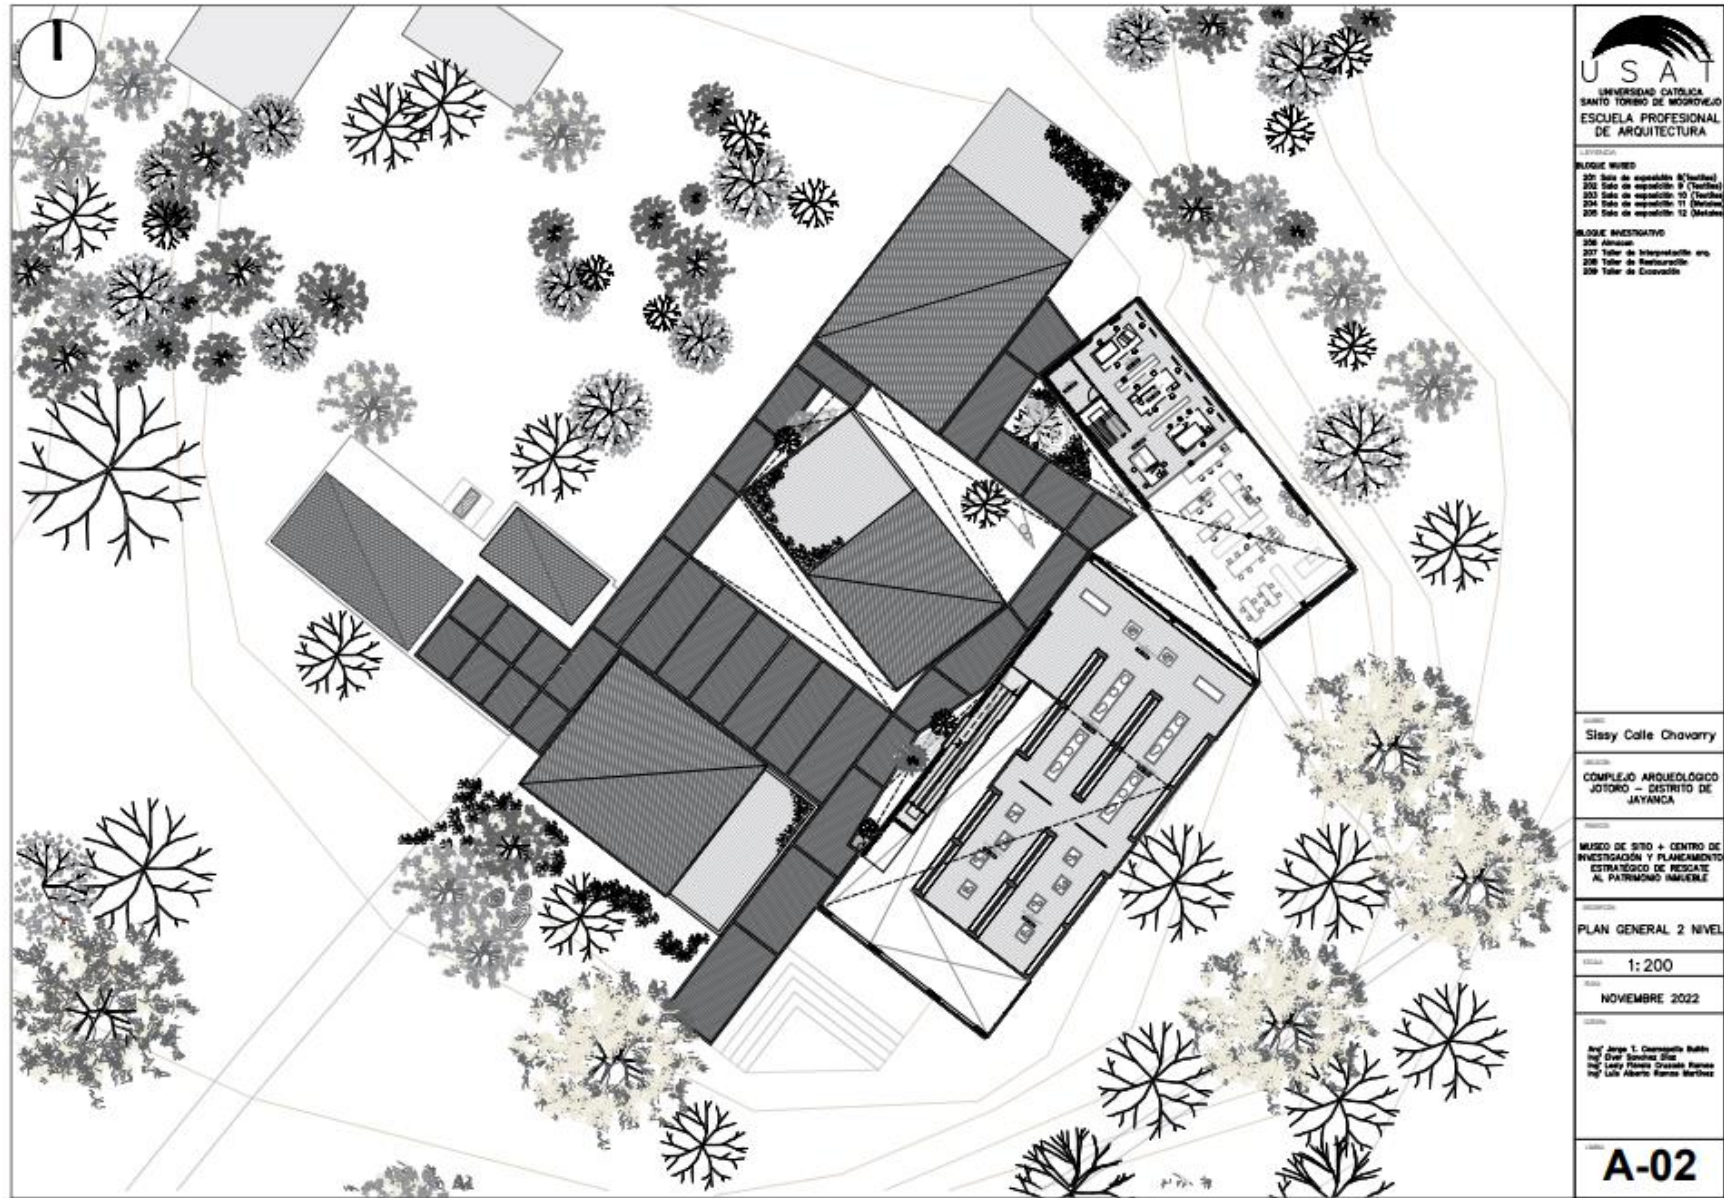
Planta arquitectónica 2do Nivel. Fuente: Propia
